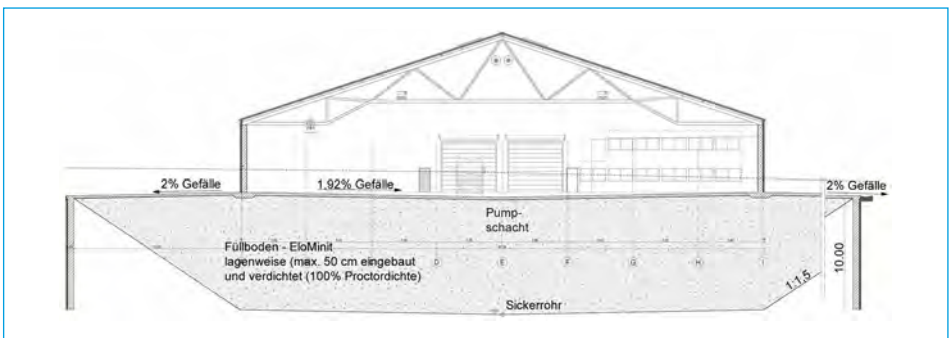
Einbau von Elektroofenschlacke im Industriebau zur Untergrundstabilisierung
